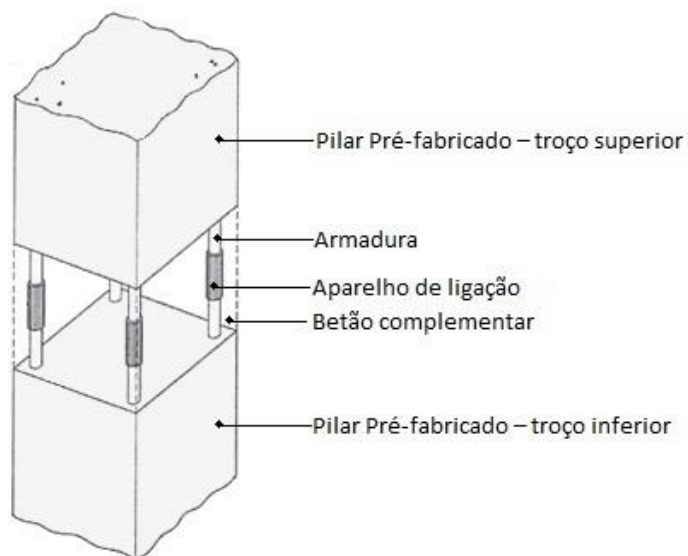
Ligação Pilar – Pilar por ligadores de varões de aço sobrepostos [46]
